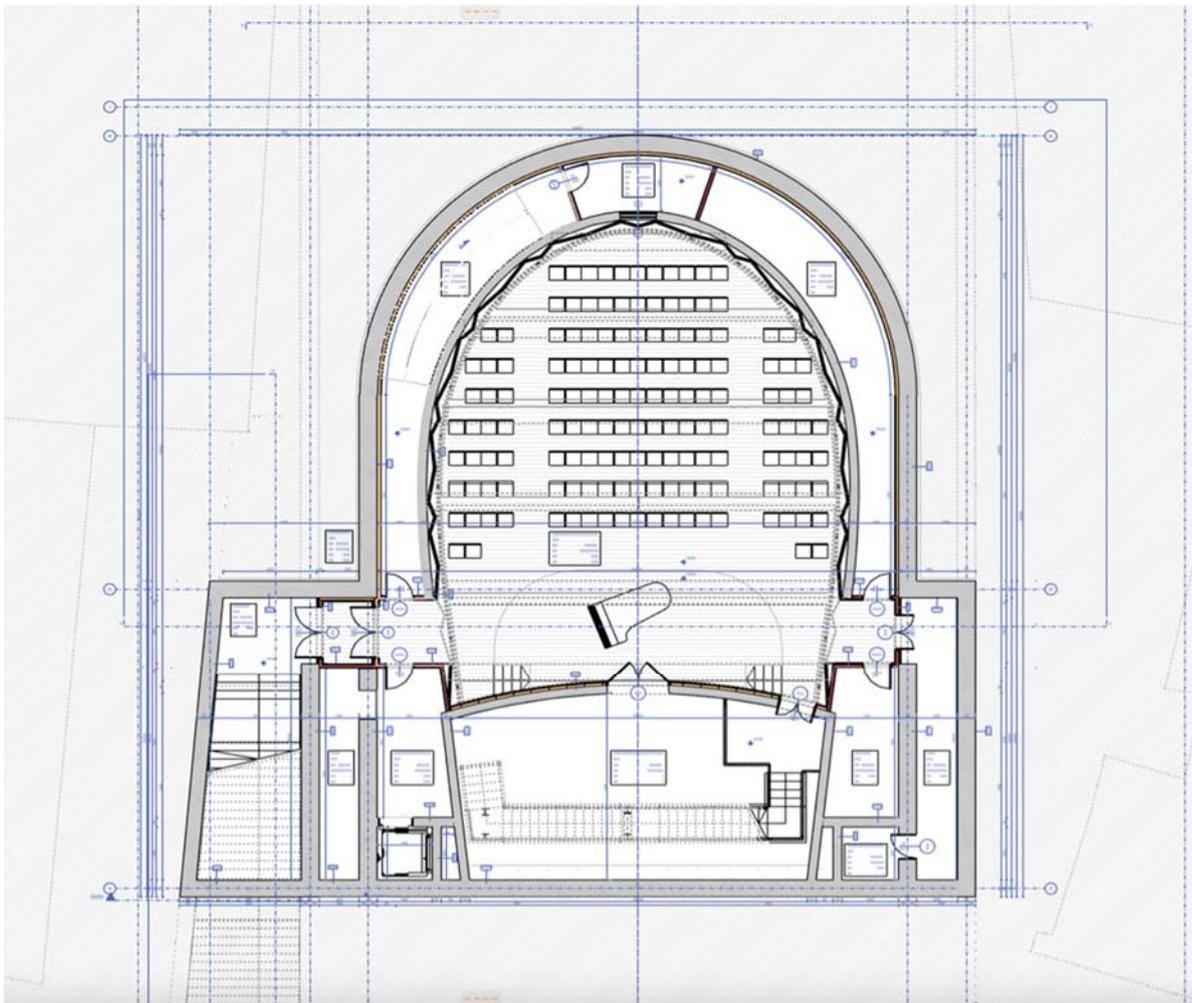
Pianta del teatro ridotto (quota -7,00 mt)
